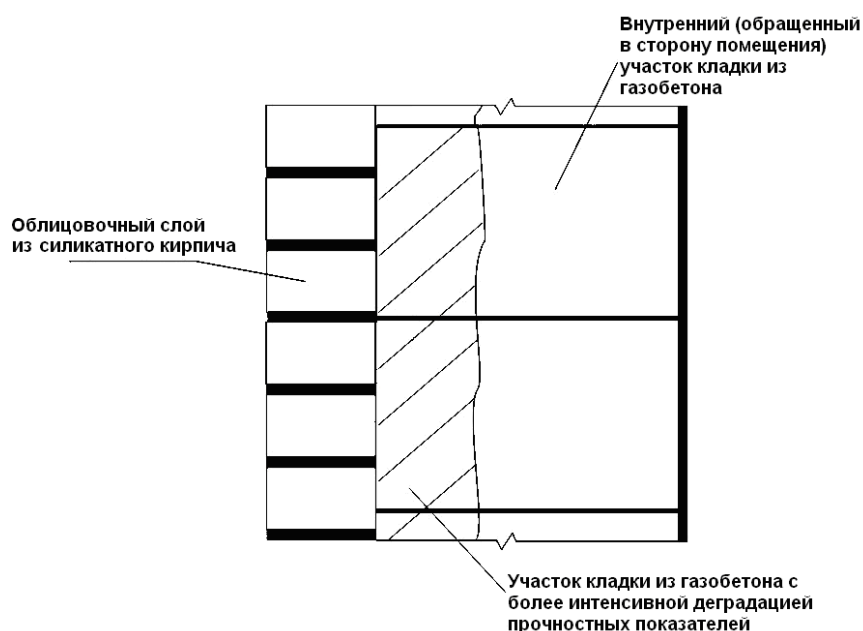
Схема разрушения испытуемой стеновой конструкции
